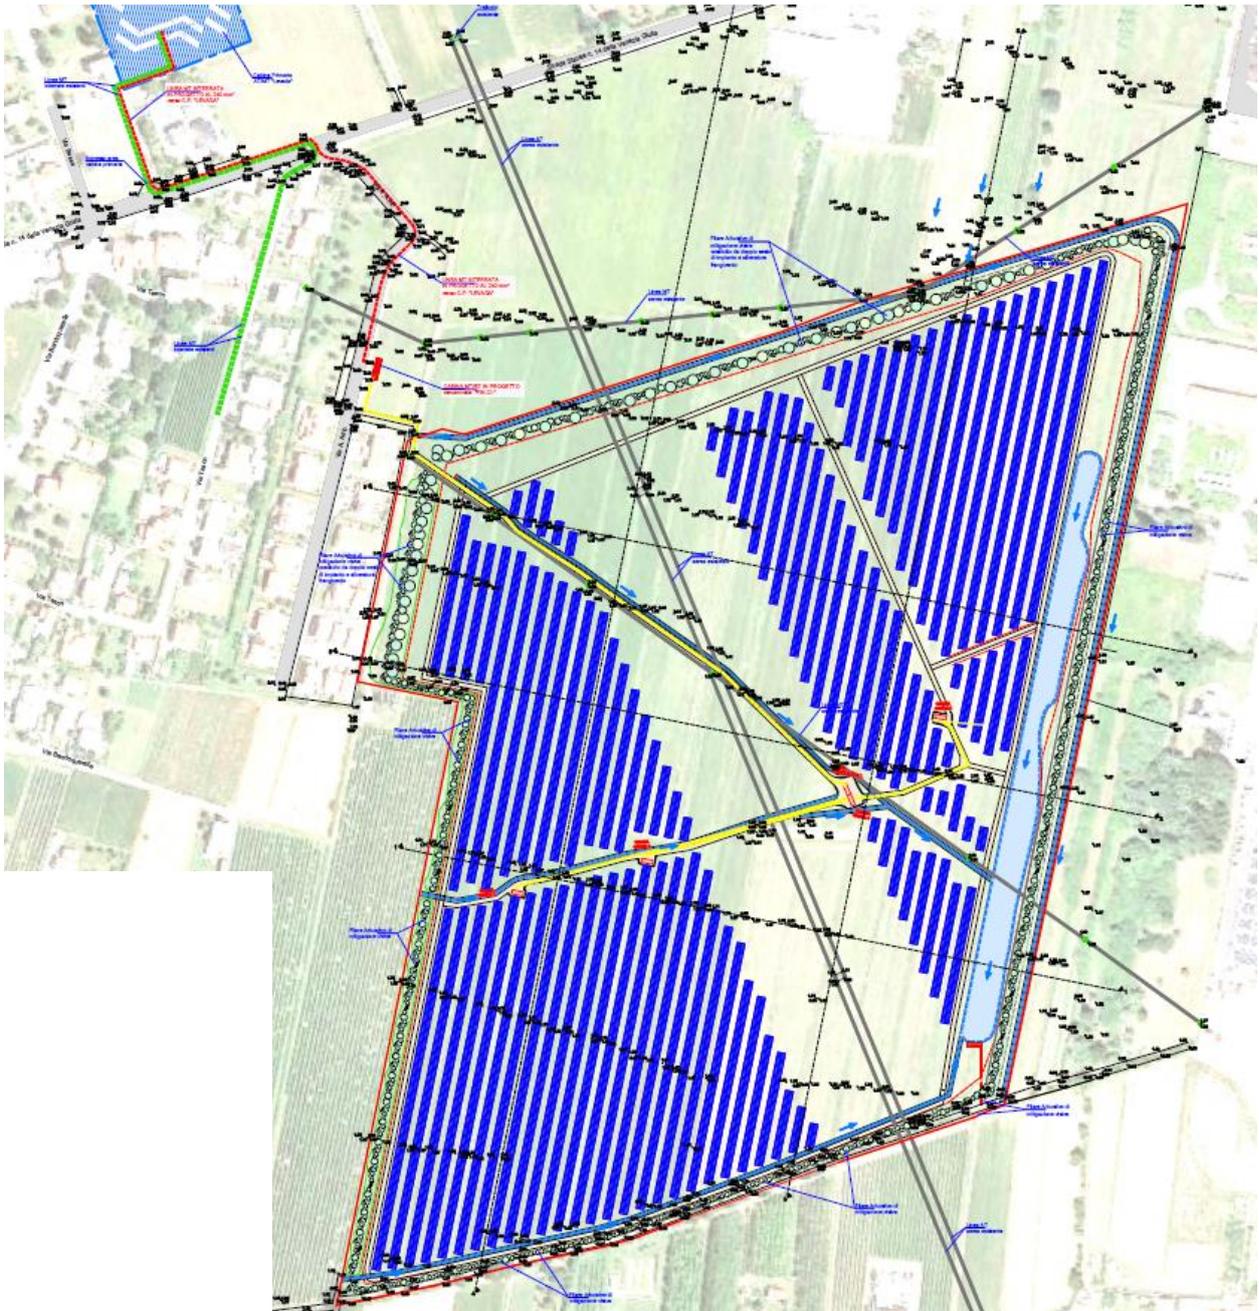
Planimetria di progetto con indicazione dei pannelli e delle principali opere
